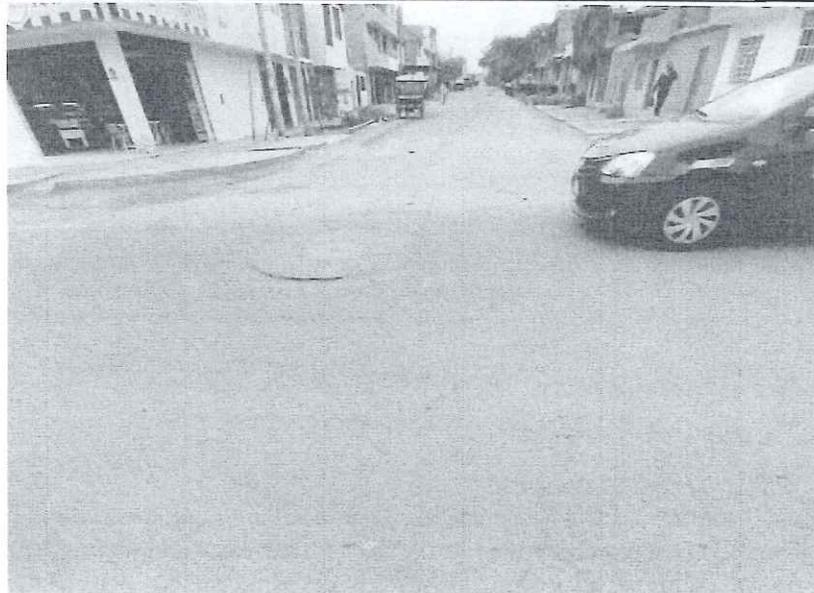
SE APRECIA GRIETAS Y FISURAS EN LA AV. EGIPTO ENTRE CALLE CHANCAY – CALLE GARCILAZO DE LA VEGA
